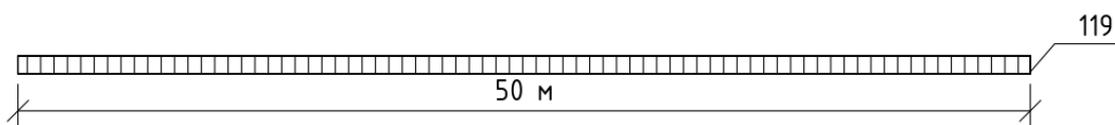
Схема распределения веса снегового покрова на плоской кровле здания
